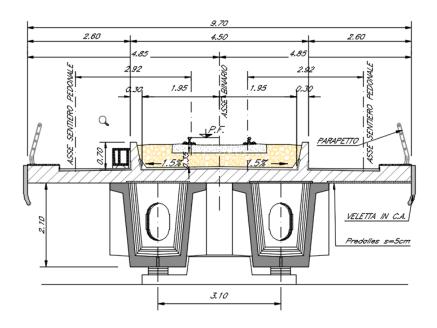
sezione trasversale impalcato tipo in cap 25m singolo binario
